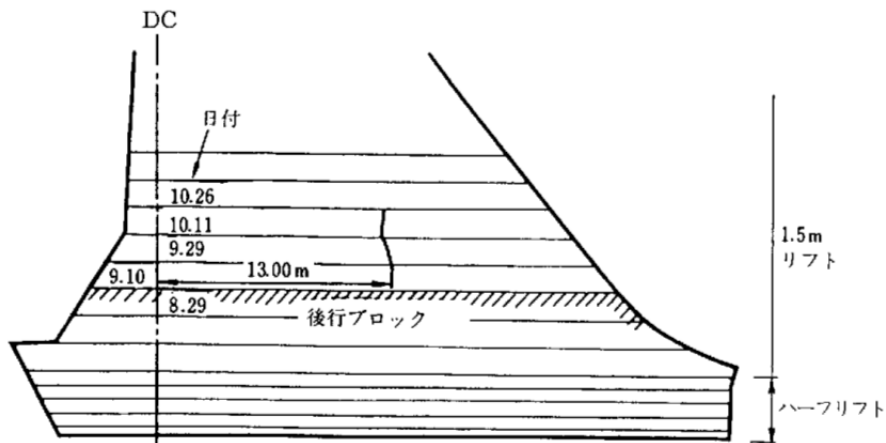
重力式コンクリートダムの先行ブロック側面に発生したひび割れの例¹⁾
